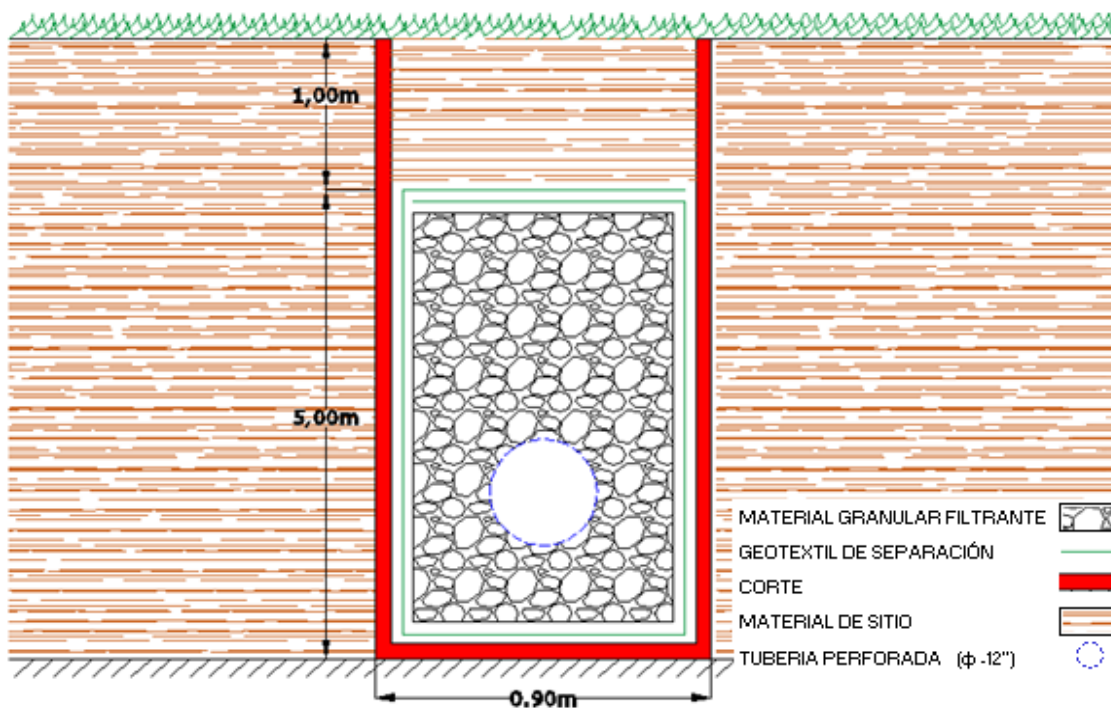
Sección típica de las zanjas o trincheras drenantes.
